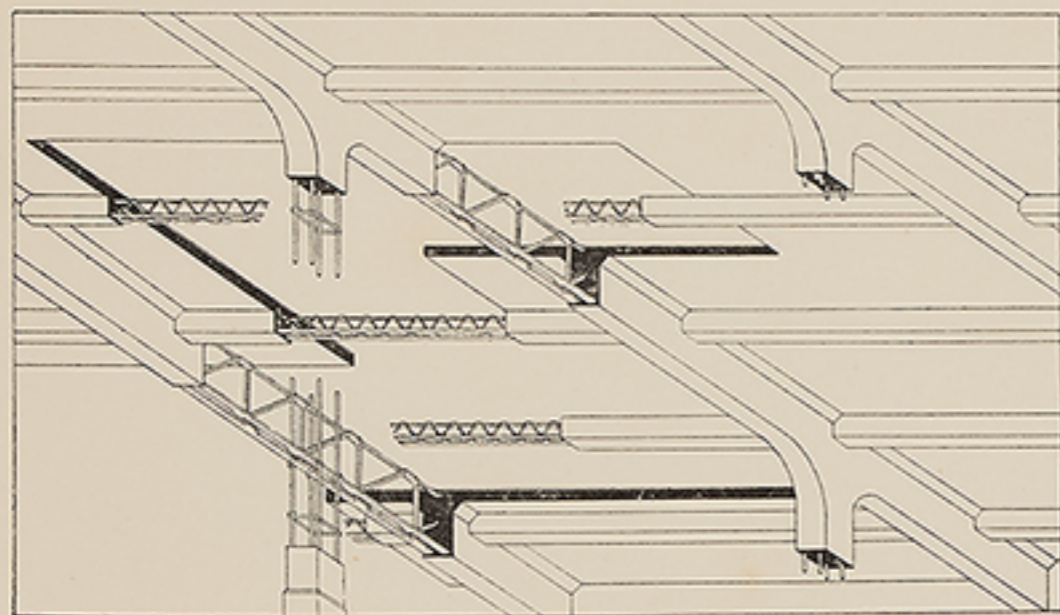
Plattenbalkendecke mit nietlosen Gitterträgern.
